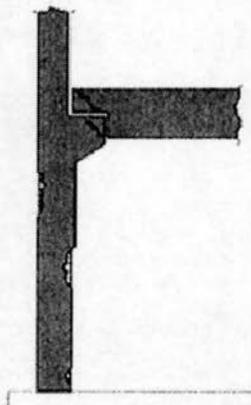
Corrosión del acero de refuerzo, fisuras y degradación del concreto
